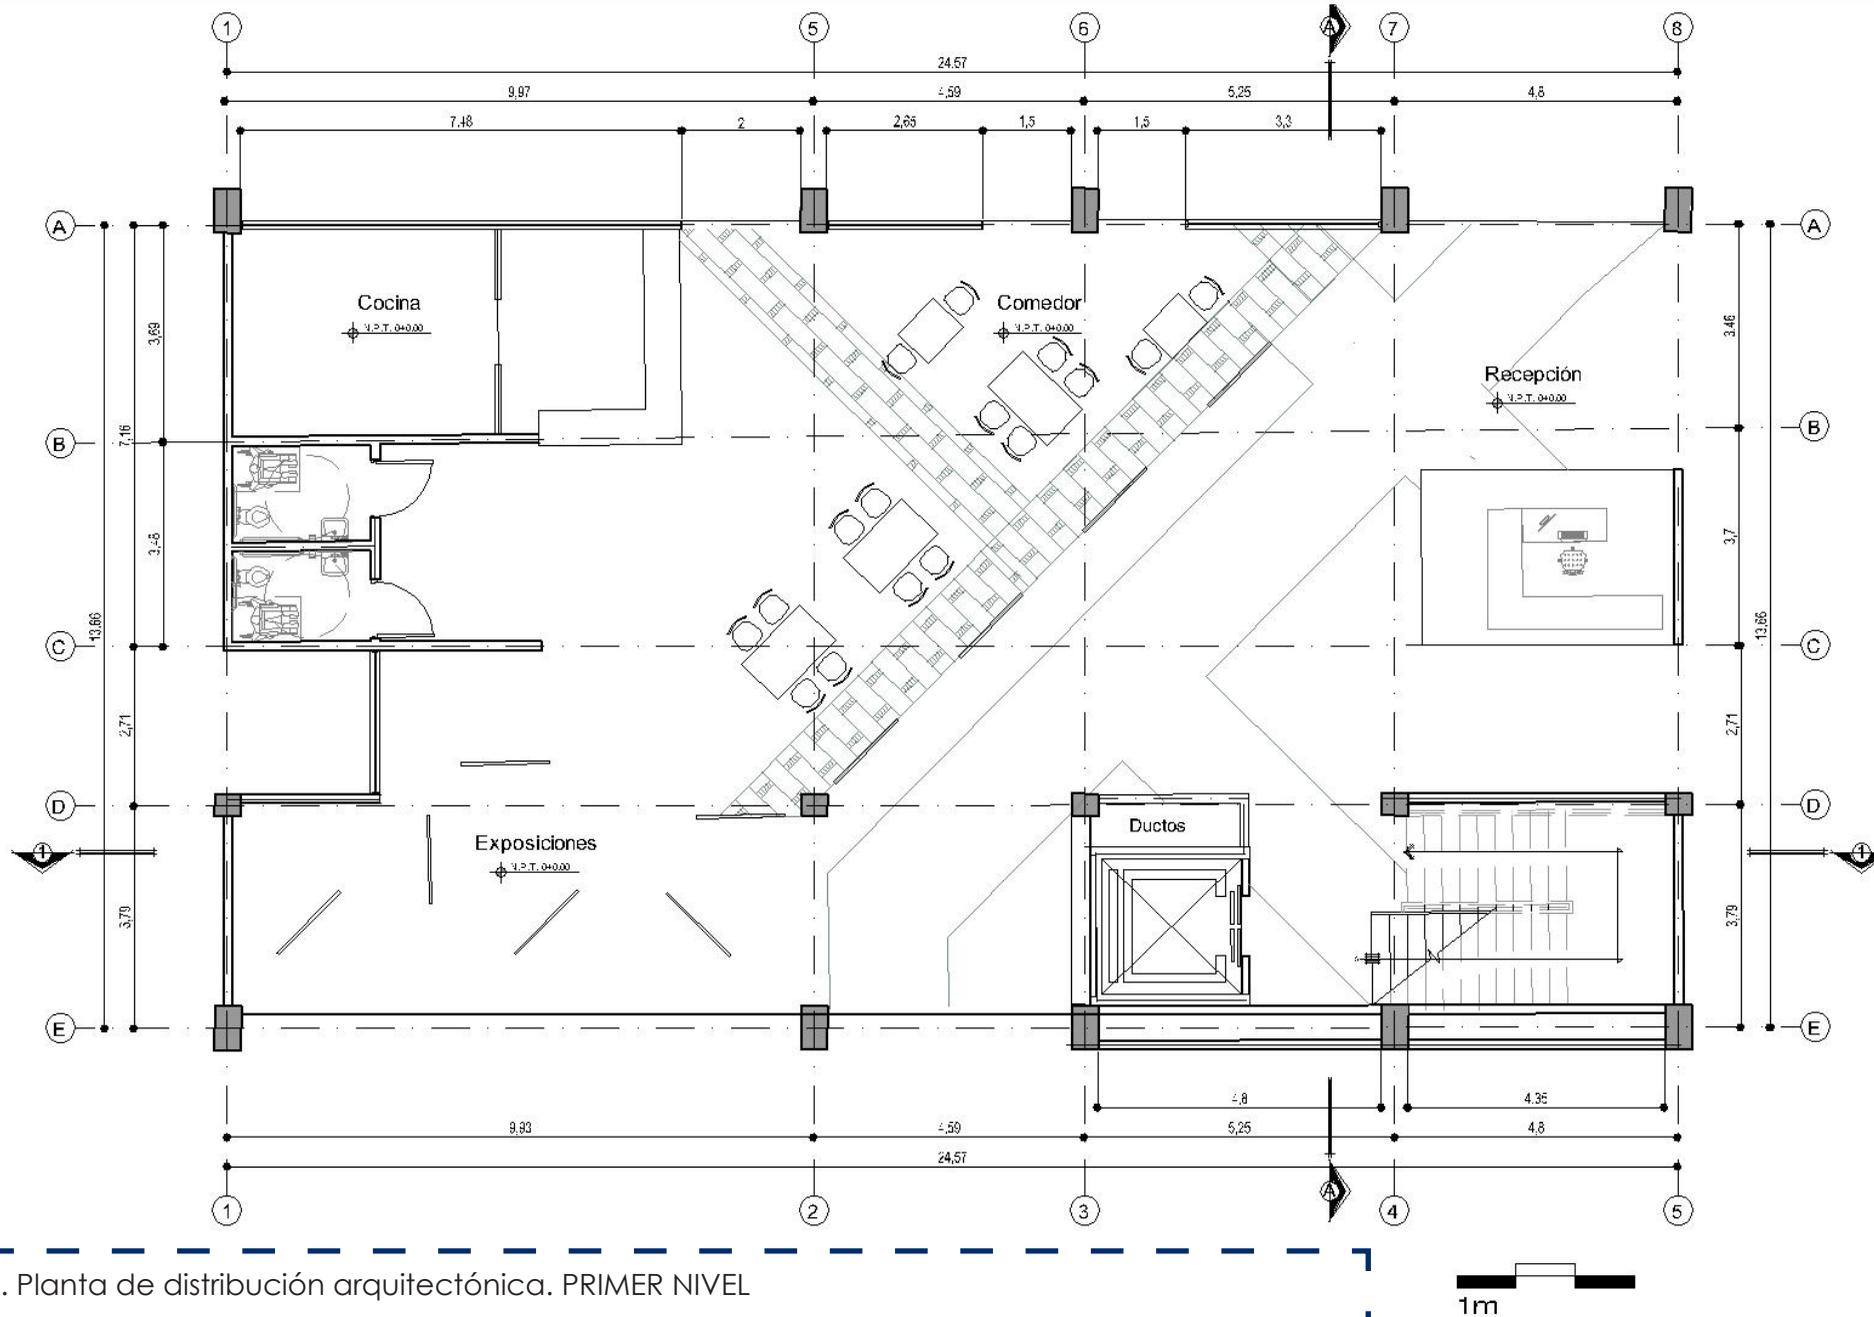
Planta de distribución arquitectónica. PRIMER NIVEL
